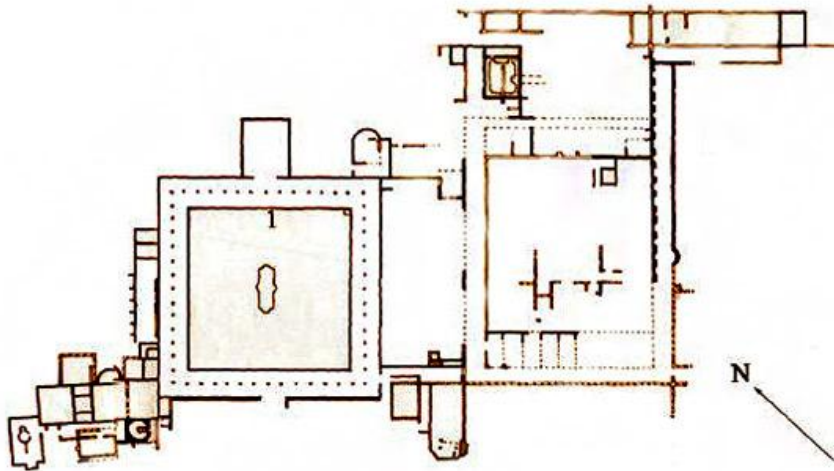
Planimetria della villa laurentina di Plinio (da www.romanoimpero.it)
